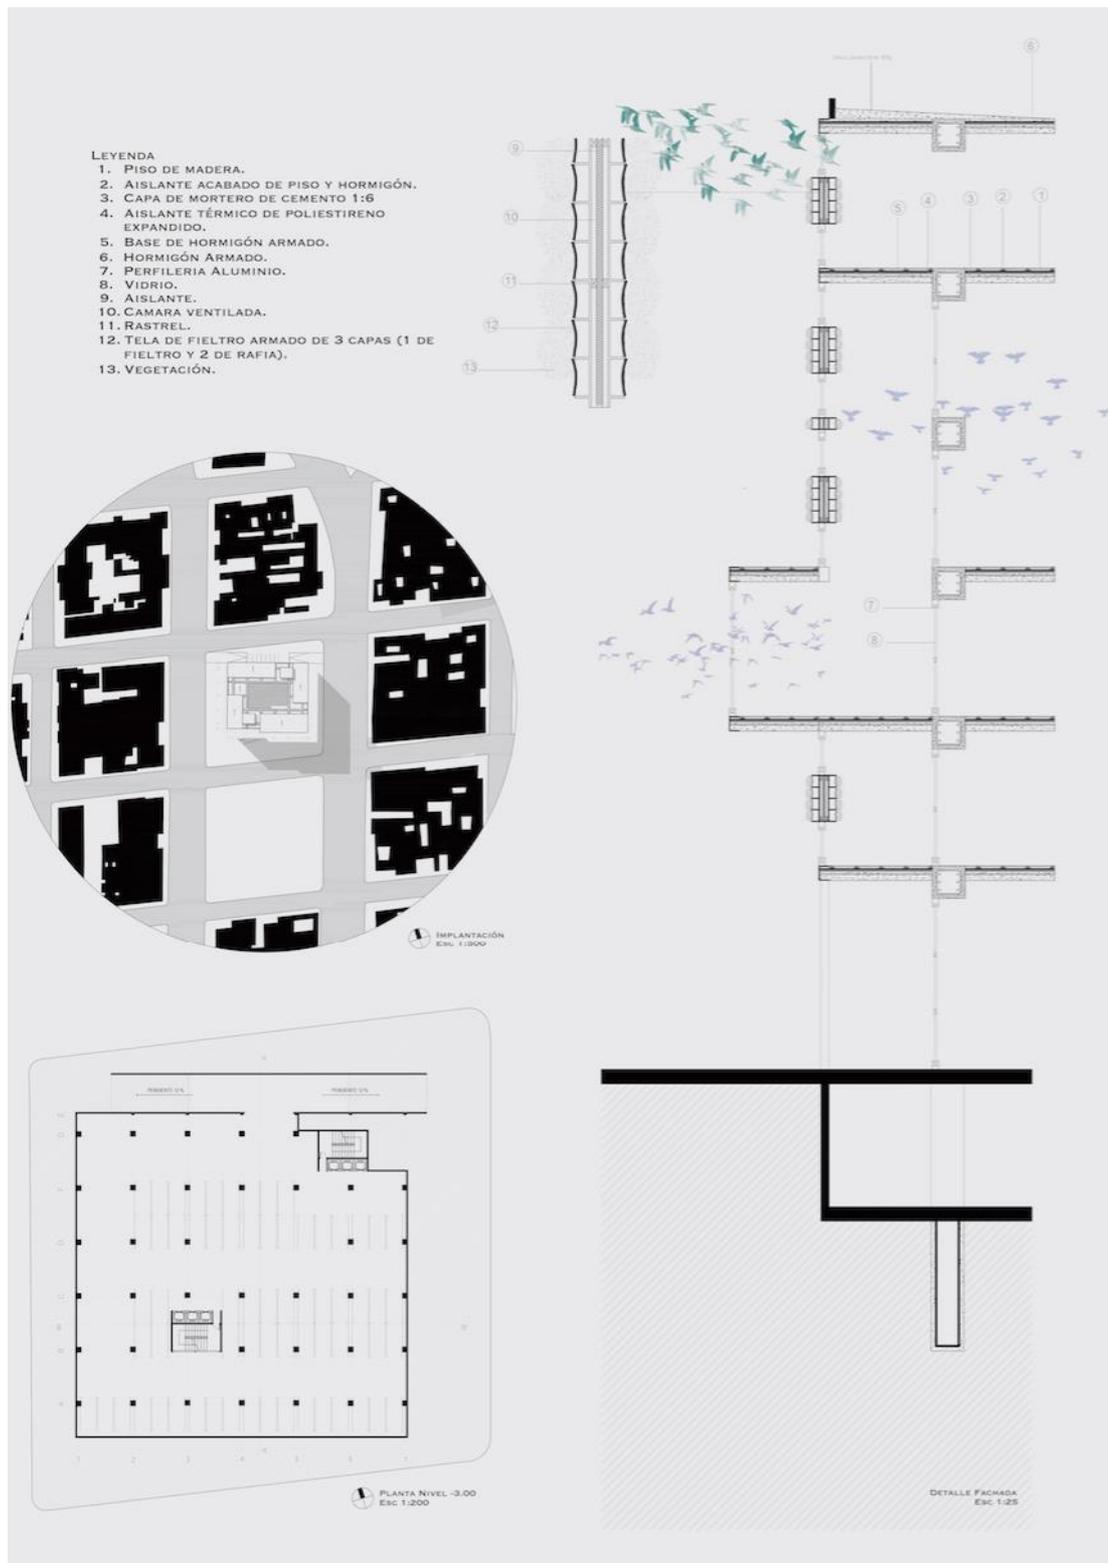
Lámina Detalle Constructivo y Planta Parqueos (Elaboración Propia)
